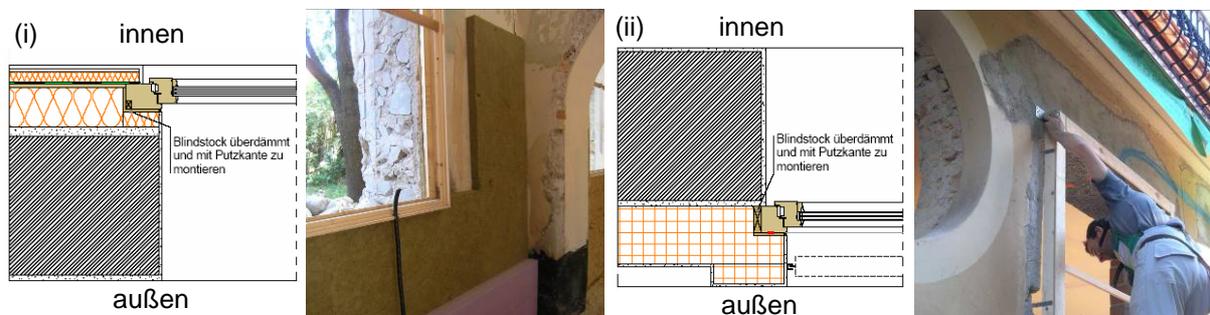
Details zum Einbau der Fenster bei (i) Innendämmung und (ii) Außendämmung
